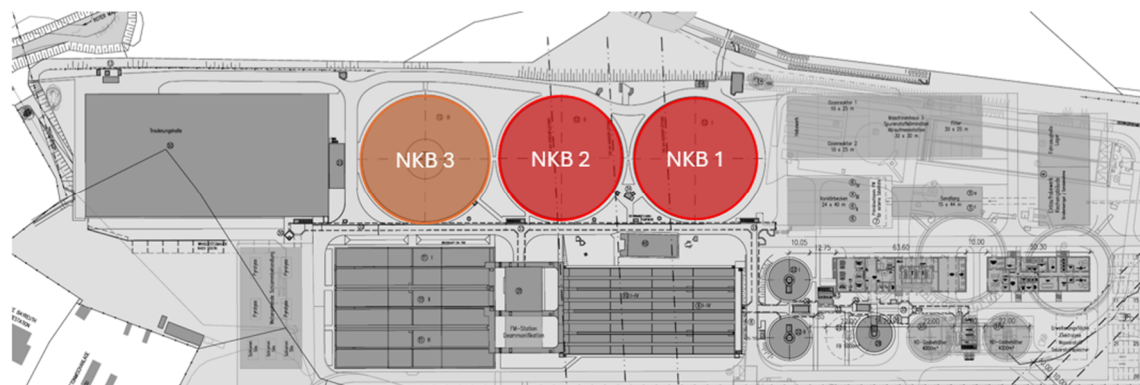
Lageplan bestehendes Nachklärbecken 3 (orange) und Neubau Nachklärbecken 1 und 2 (rot)
